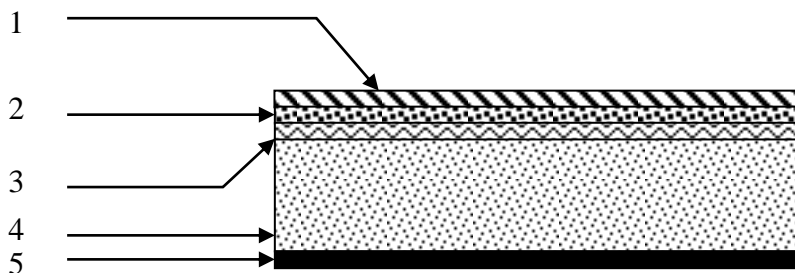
Schéma représente détail d'une dalle pleine (vue en plan).
